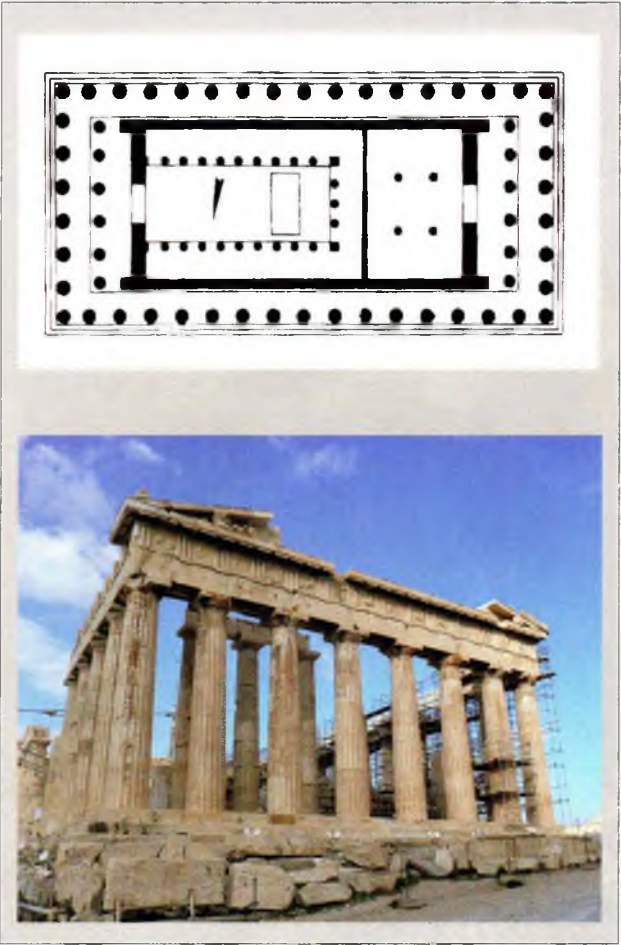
El Partenón (la planta de G. Richter). Debajo, fachada oriental del edificio.
